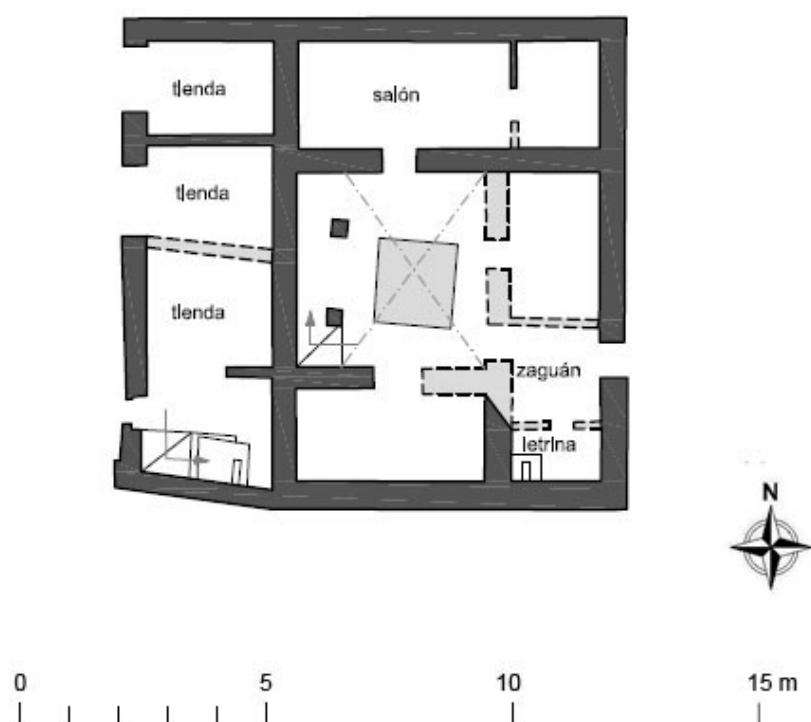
Tiendas y casa de calle La Manga. Croquis
